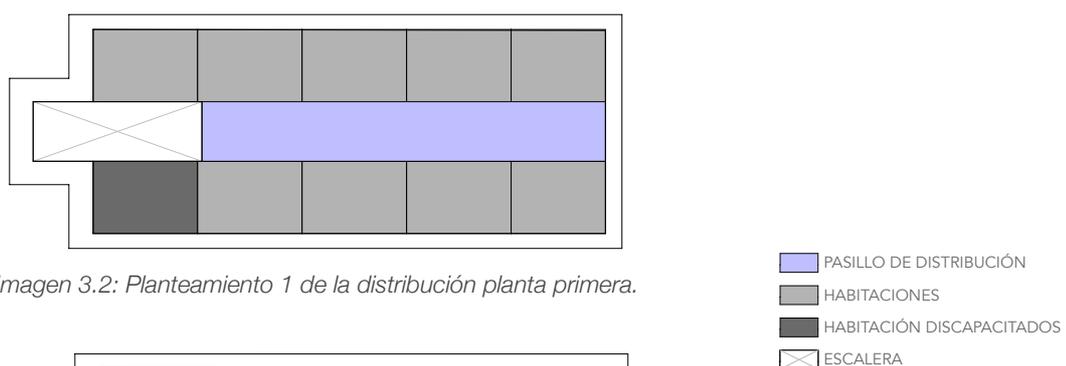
Planteamiento 1 de la distribución planta primera.
